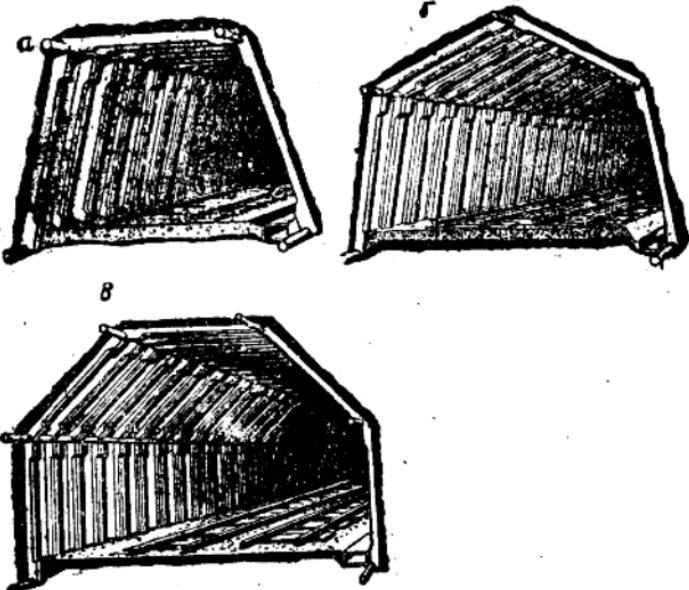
装配式钢筋混凝土密置支架保护的桥道全貌
